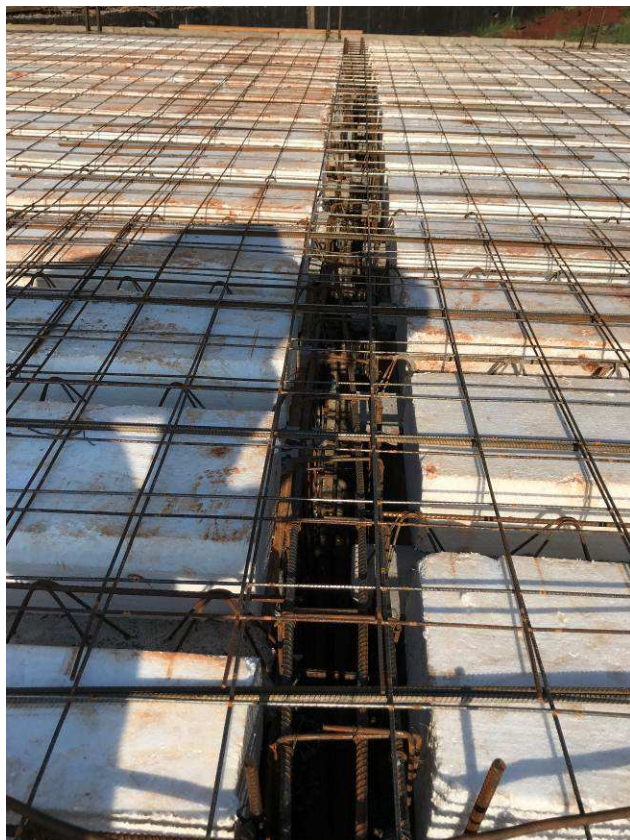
C: Laje e vigas de cobertura do prédio principal - eixos 1-5 e G-I.
